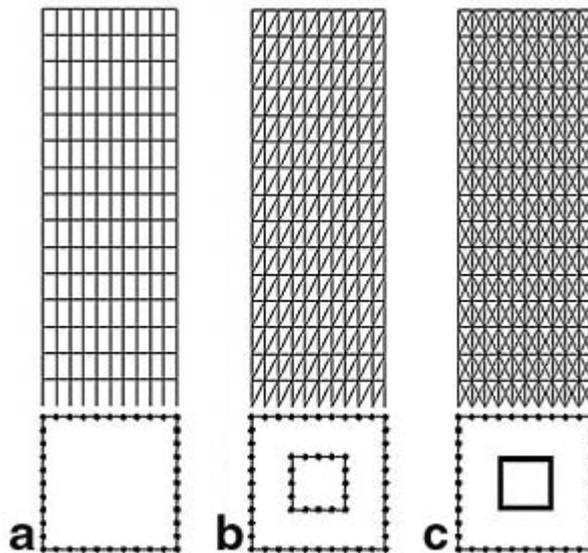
Estruturas de contraventamento para mega edifícios altos: a) tubular periférico; b) tubular treliçado + tubular central; c) tubular treliçado + núcleo central [26]
